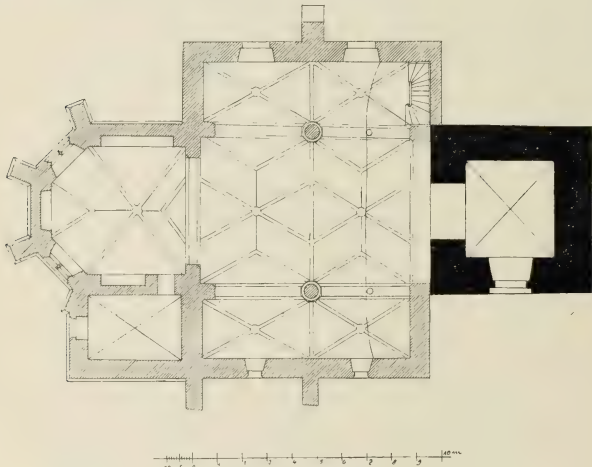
Schoenau. Grundriss der kath. Pfarrkirche vor der Erweiterung.
